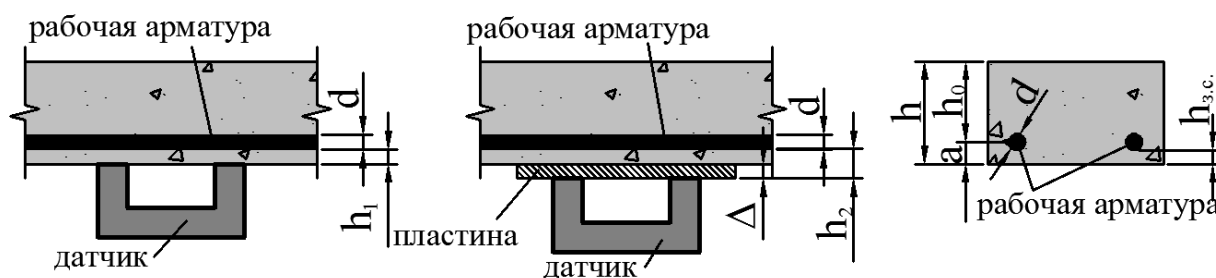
Схема определения диаметра арматуры и величины защитного слоя бетона железобетонной балки
